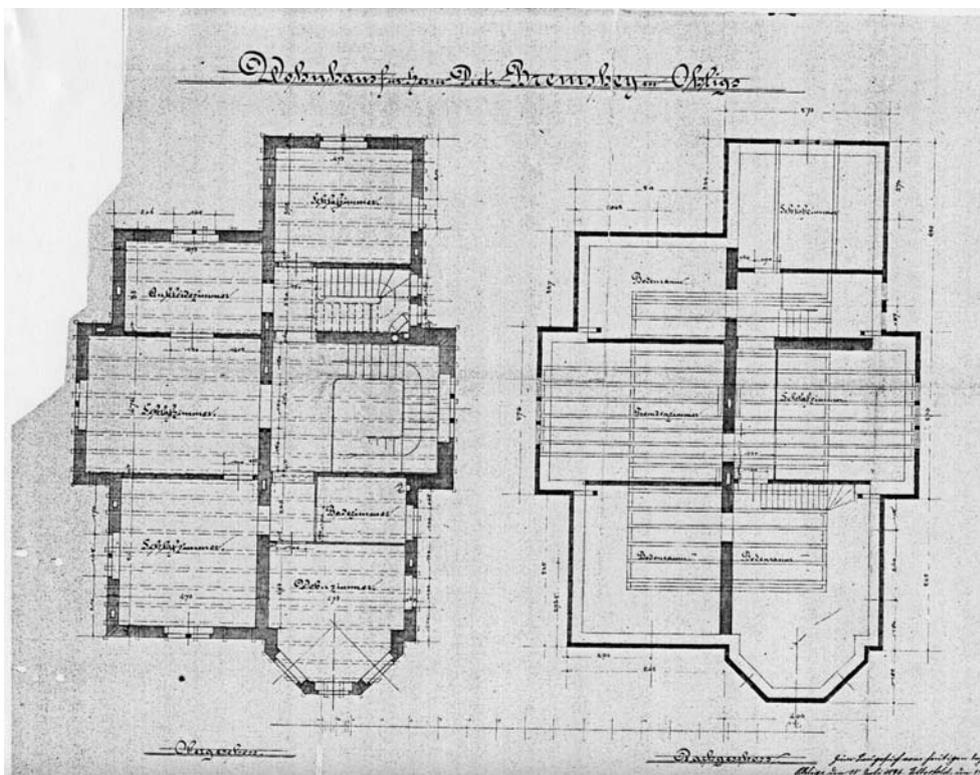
H. Plange, Grundriss Obergeschoss (links) und Dachgeschoss, 1896
